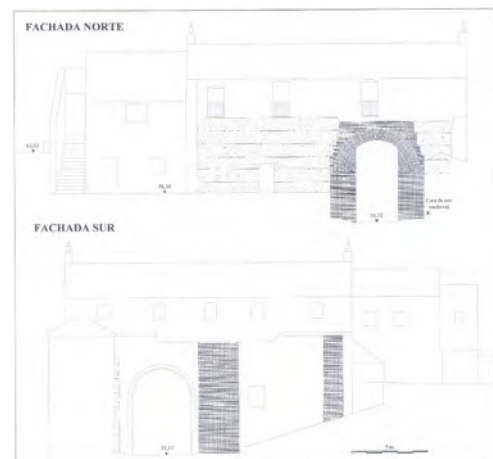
Elementos islámicos sobre fachadas norte y sur del edificio.
